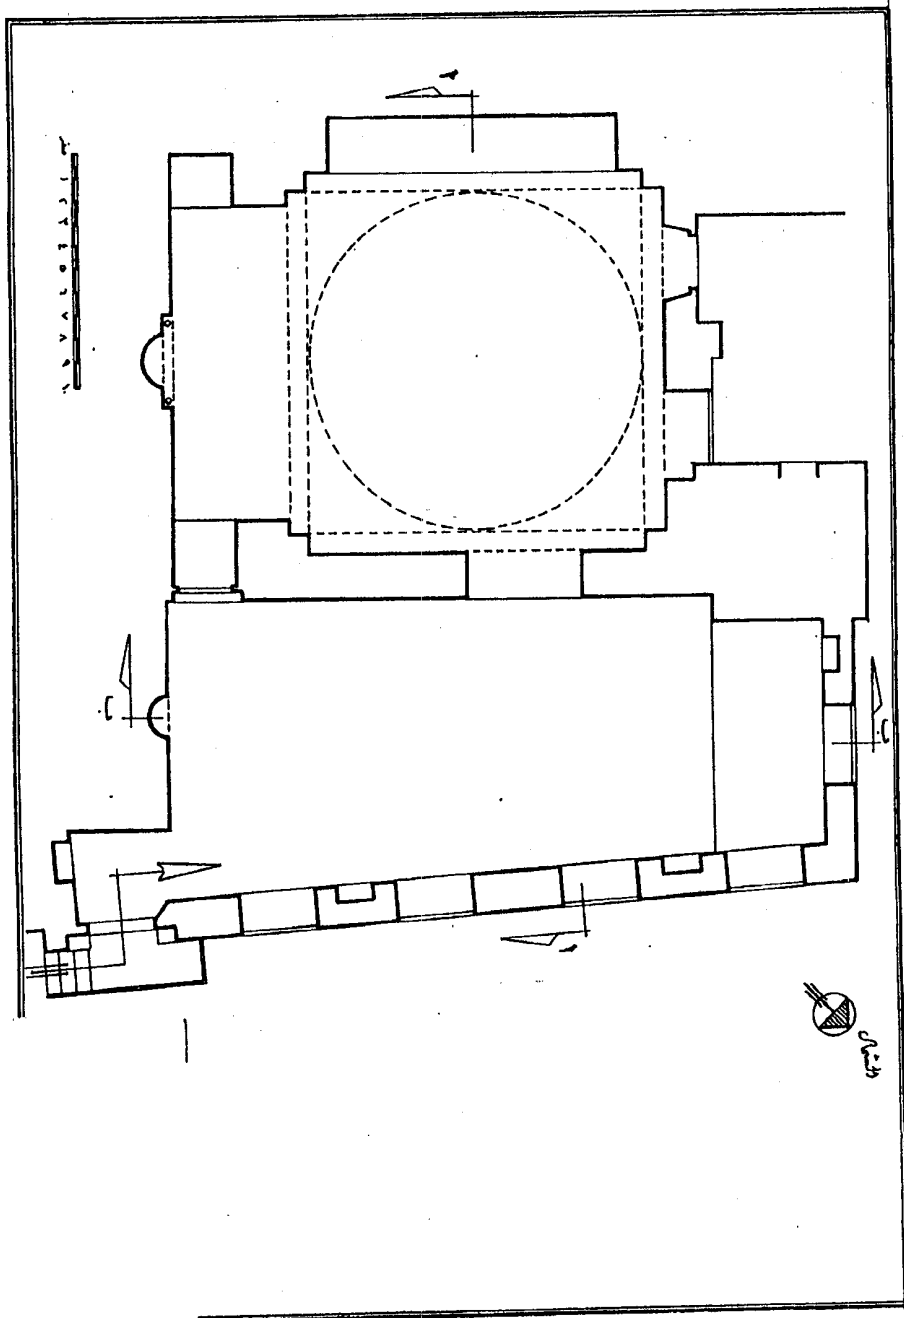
مسقط أفقي لجامع لاله لي في استانبول
